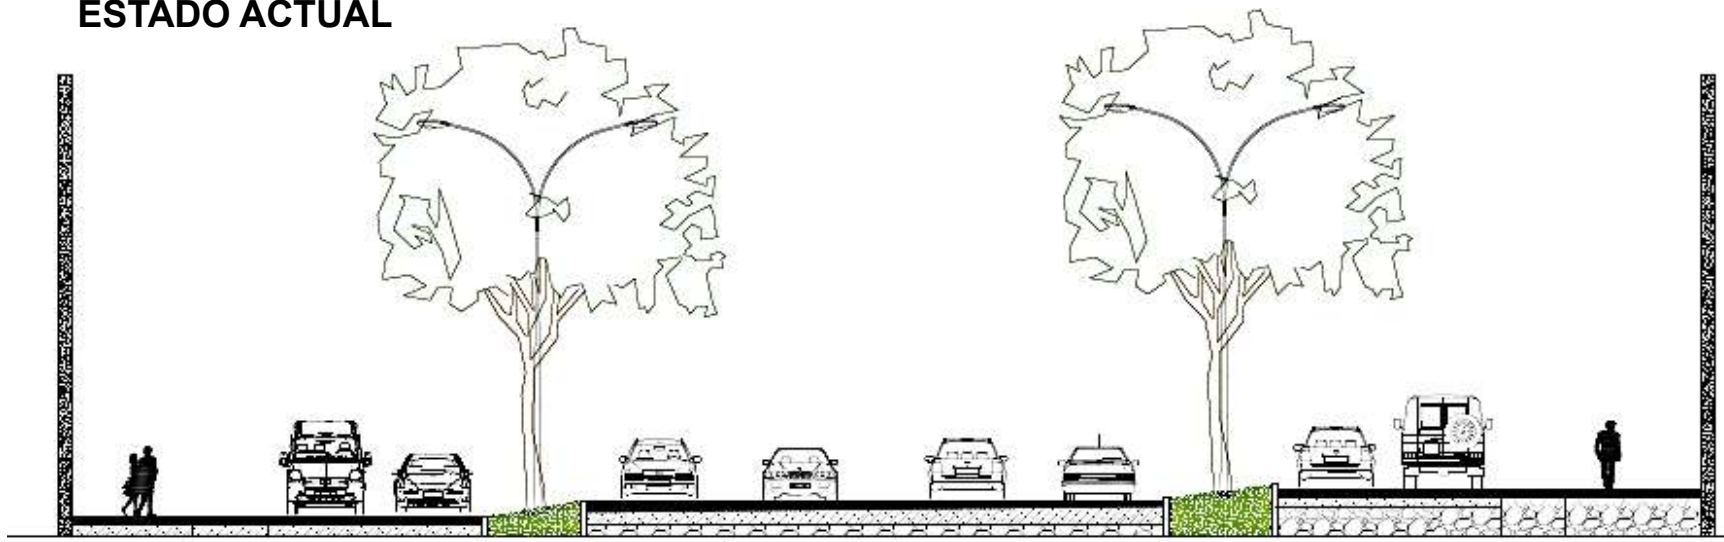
Sección actual de Av. Madero Poniente con calle Puerto Ángel
